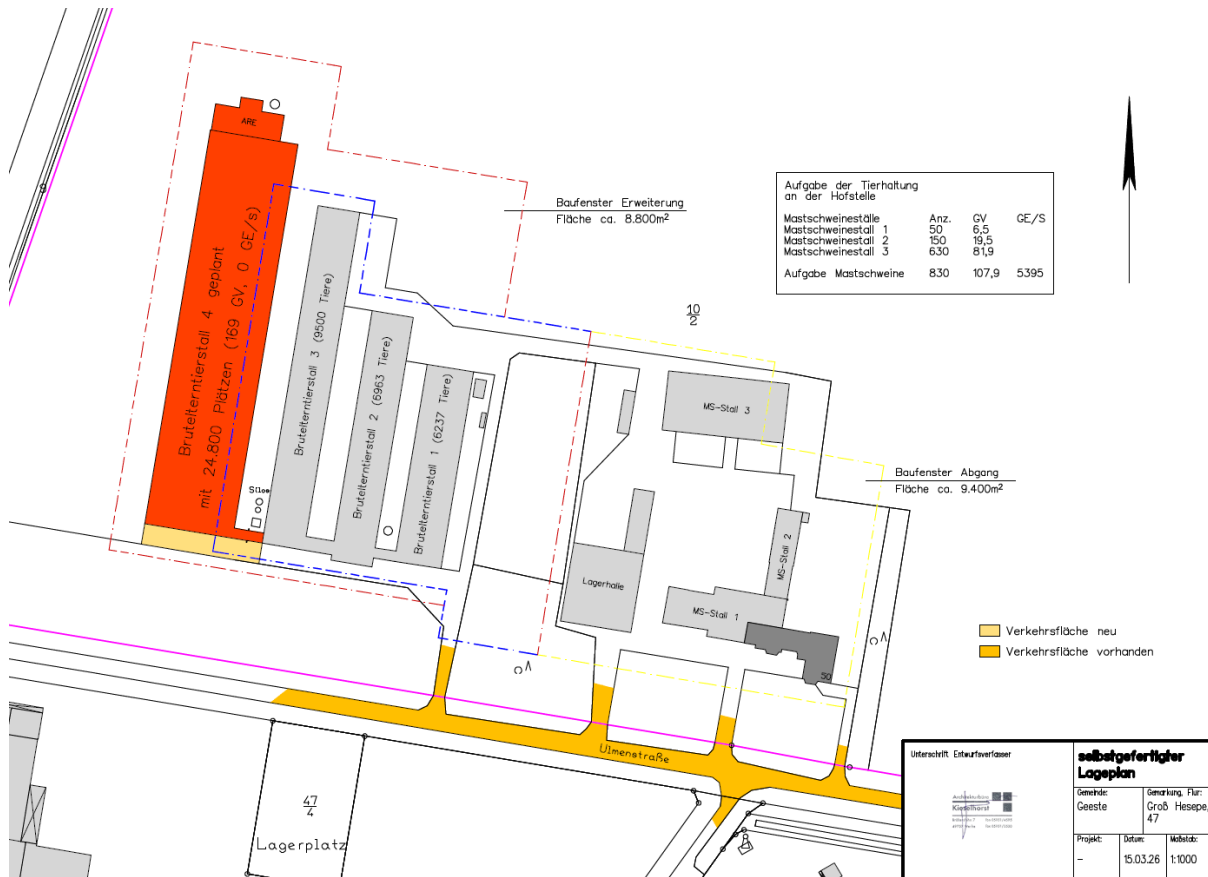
Lageplan zum Bauvorhaben (Kieselhorst 2026) (unmaßstäblich)
